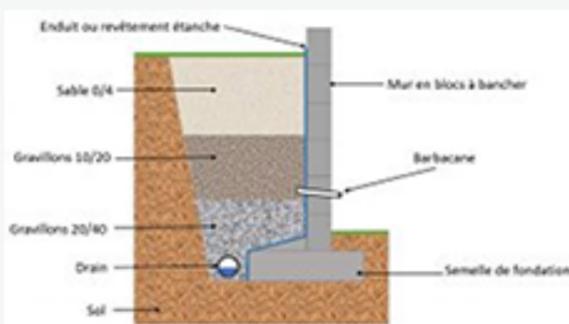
FIGURE: PRINCIPE DE RÉALISATION D'UN MUR DE SOUTÈNEMENT EN BLOCS À BANCHER. SOURCE : [HTTPS://WWW.TOUTSURLEBETON.FR](https://www.toutsurlebeton.fr)
